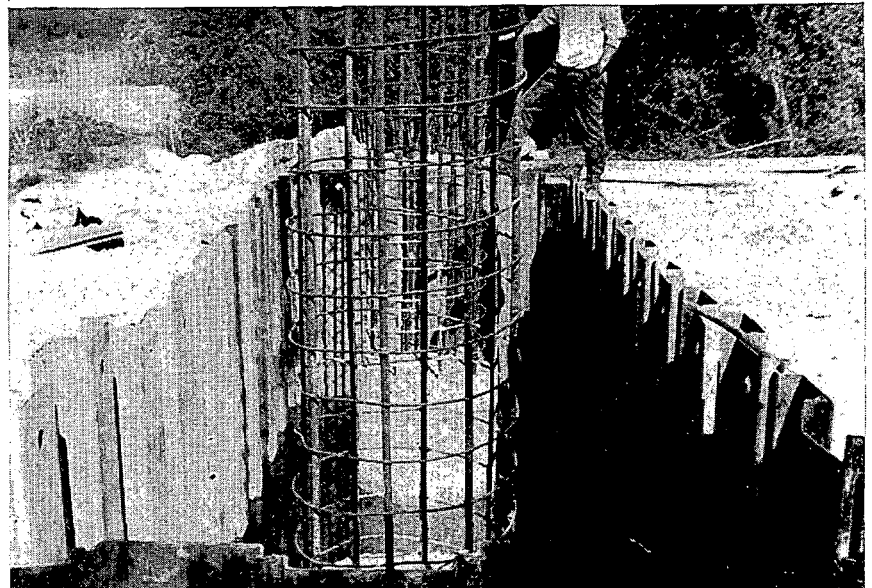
Recintos tablestacados para cimentación de las pilas de los puentes de las autopistas de Barcelona a La Junquera, en Hostalrich.
